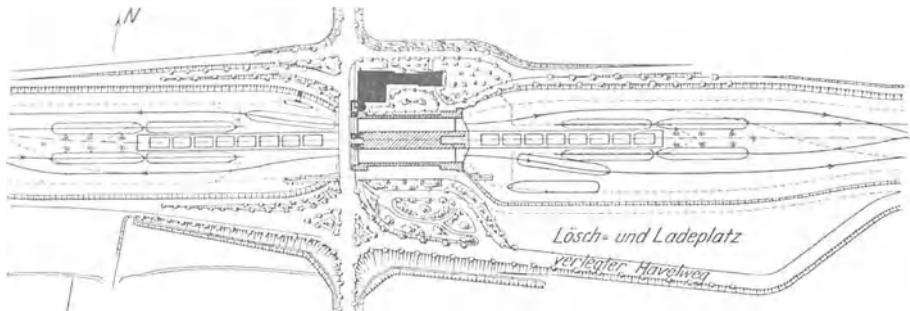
Lageplan der Schleusenanlage bei Klein-Machnow.
